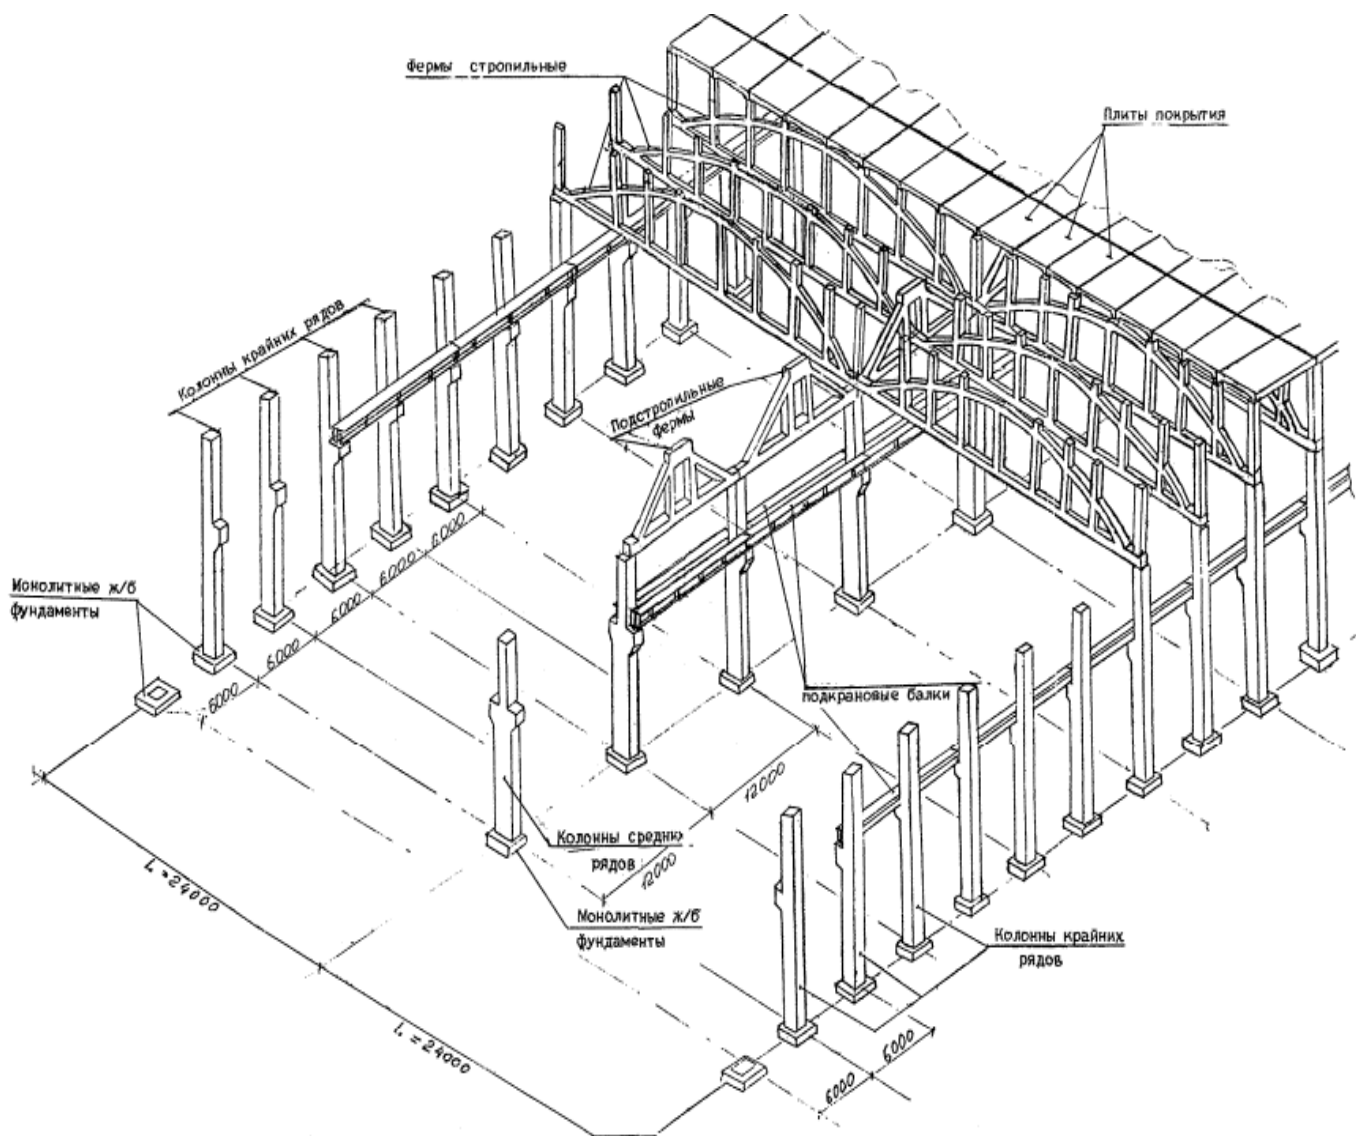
Схема конструктивних рішень одноповерхової промислової будівлі зі збірних залізобетонних елементів
